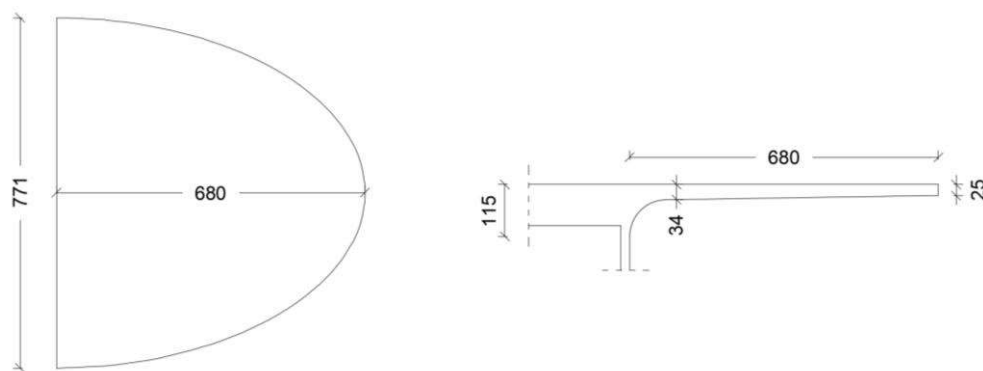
Pianta e sezione della pensilina semi-ellittica di Maratona
